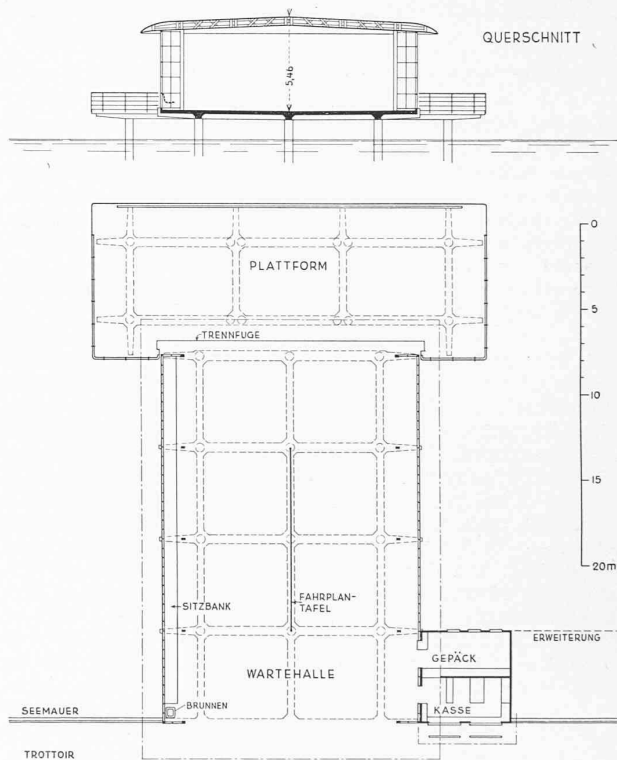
u. 4. Grundriss und Querschnitt. — Masstab 1 : 400
